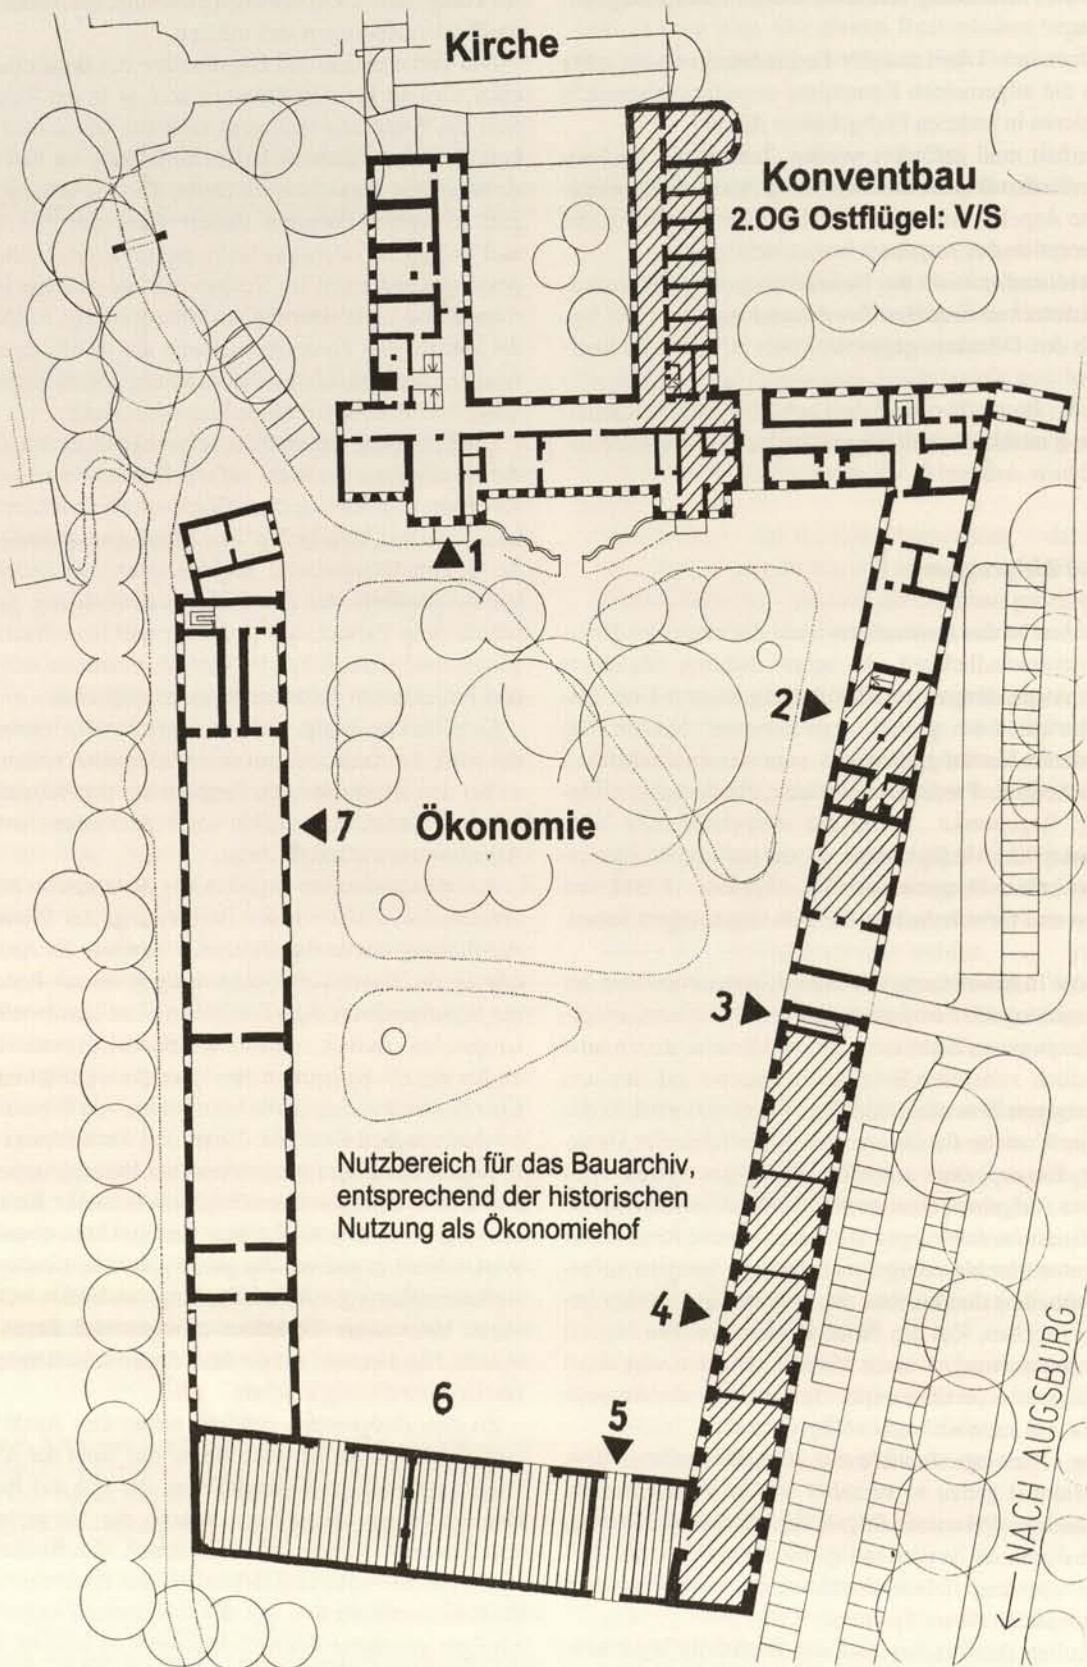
Thierhaupten, Lkr. Augsburg, Lageplan des ehem. Klosterkomplexes. Schräg schraffiert die vom Bayerischen Bauarchiv und seinen Bauwerkstätten genutzten Flächen, senkrecht schraffiert die nach dem Konzept des Verfassers geplanten weiteren, später jedoch geänderten Nutzungen.
